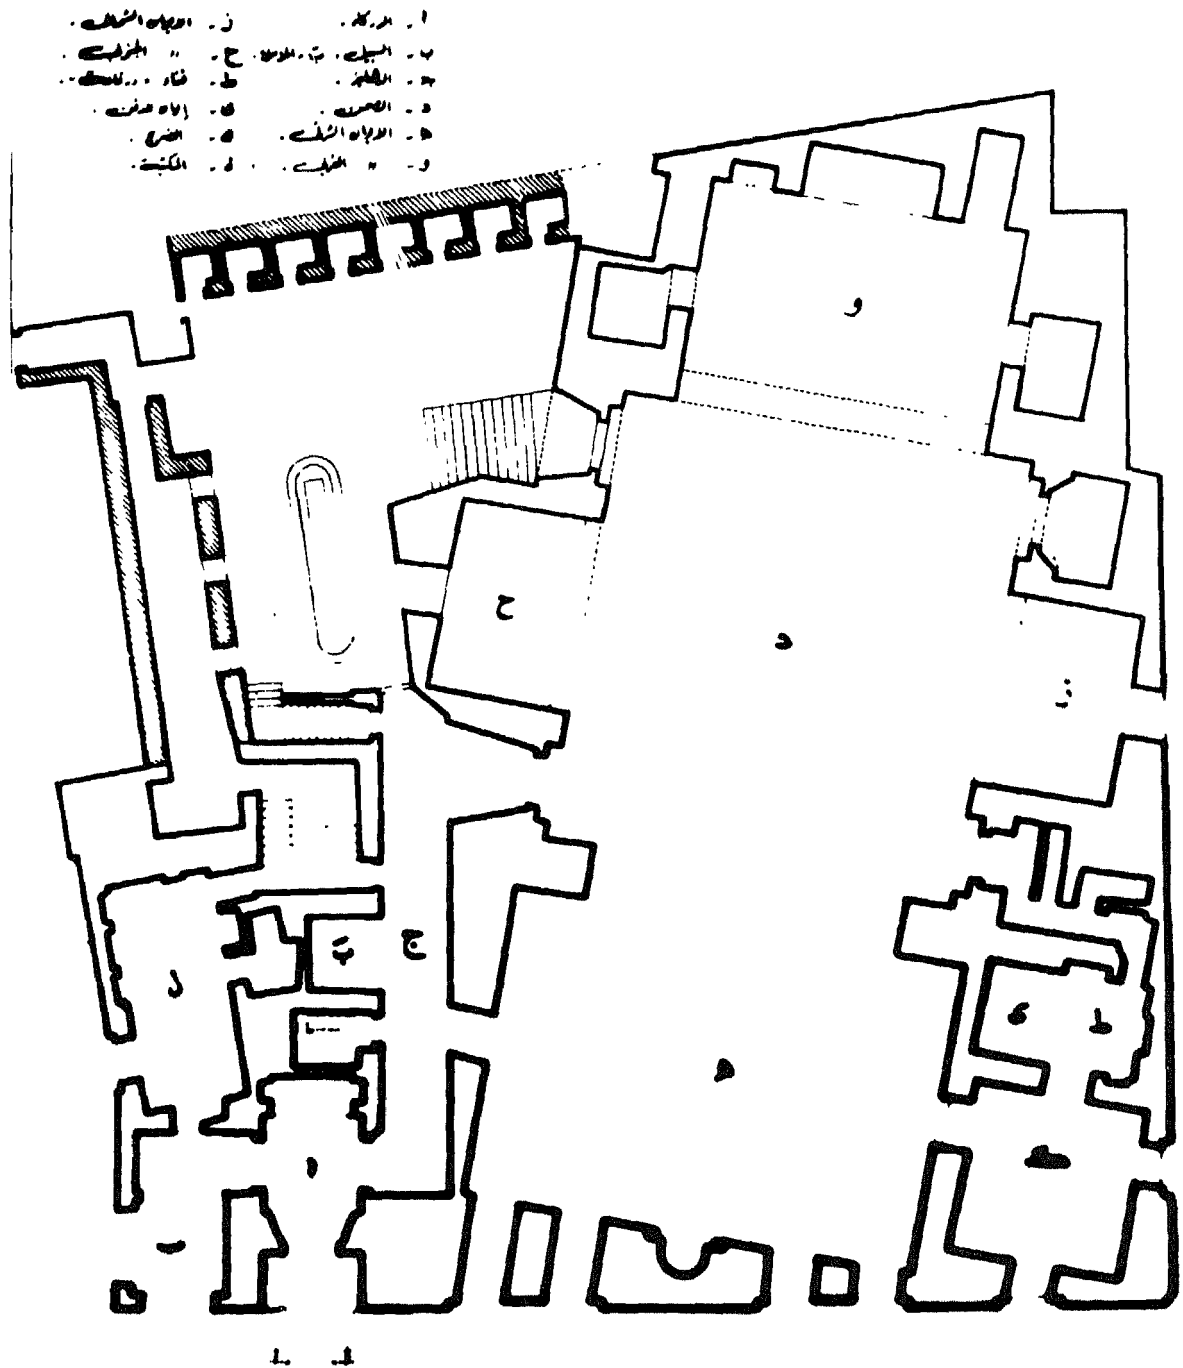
تبين مسقط أفقى لمدرسة وخانقاه برقوق بشارع المعز لدين الله
